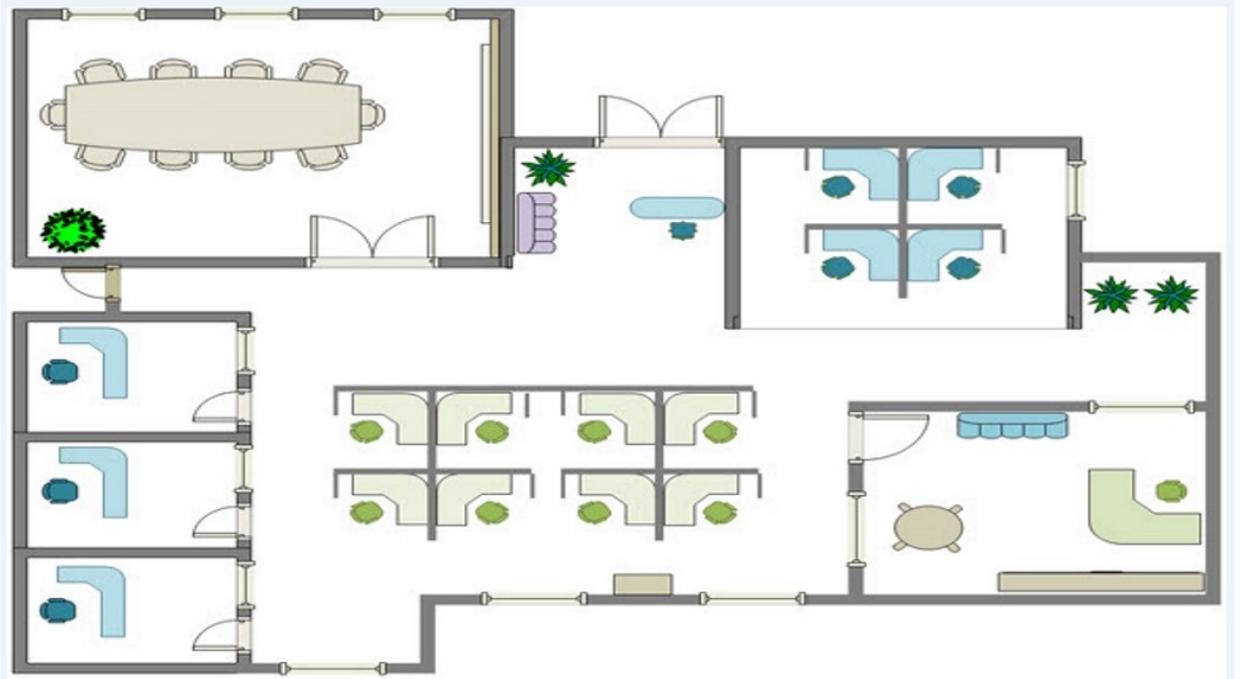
Choisir une image de plan existant ou créer un dessin puis l'enregistrer aux dimensions choisies. Si vous souhaitez que votre nouveau plan soit aux mêmes dimensions que le plan par défaut menu.jpg choisir les dimensions 1024 x 432. Le plan ainsi crée doit être de format jpg .
